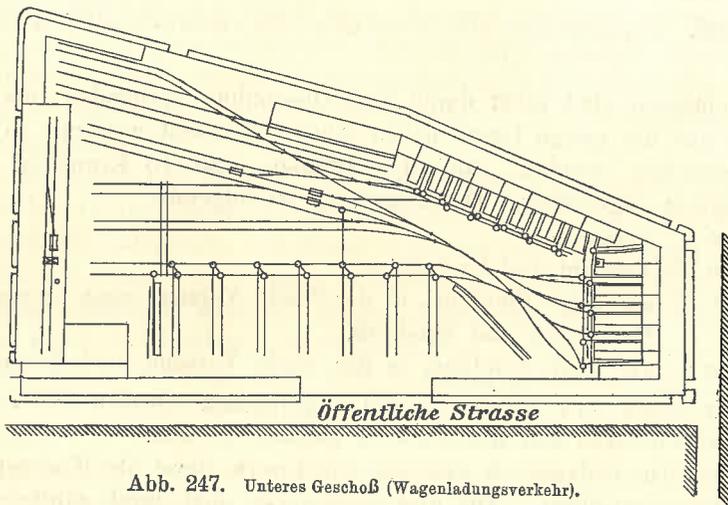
Unteres Geschoß (Wagenladungsverkehr).
